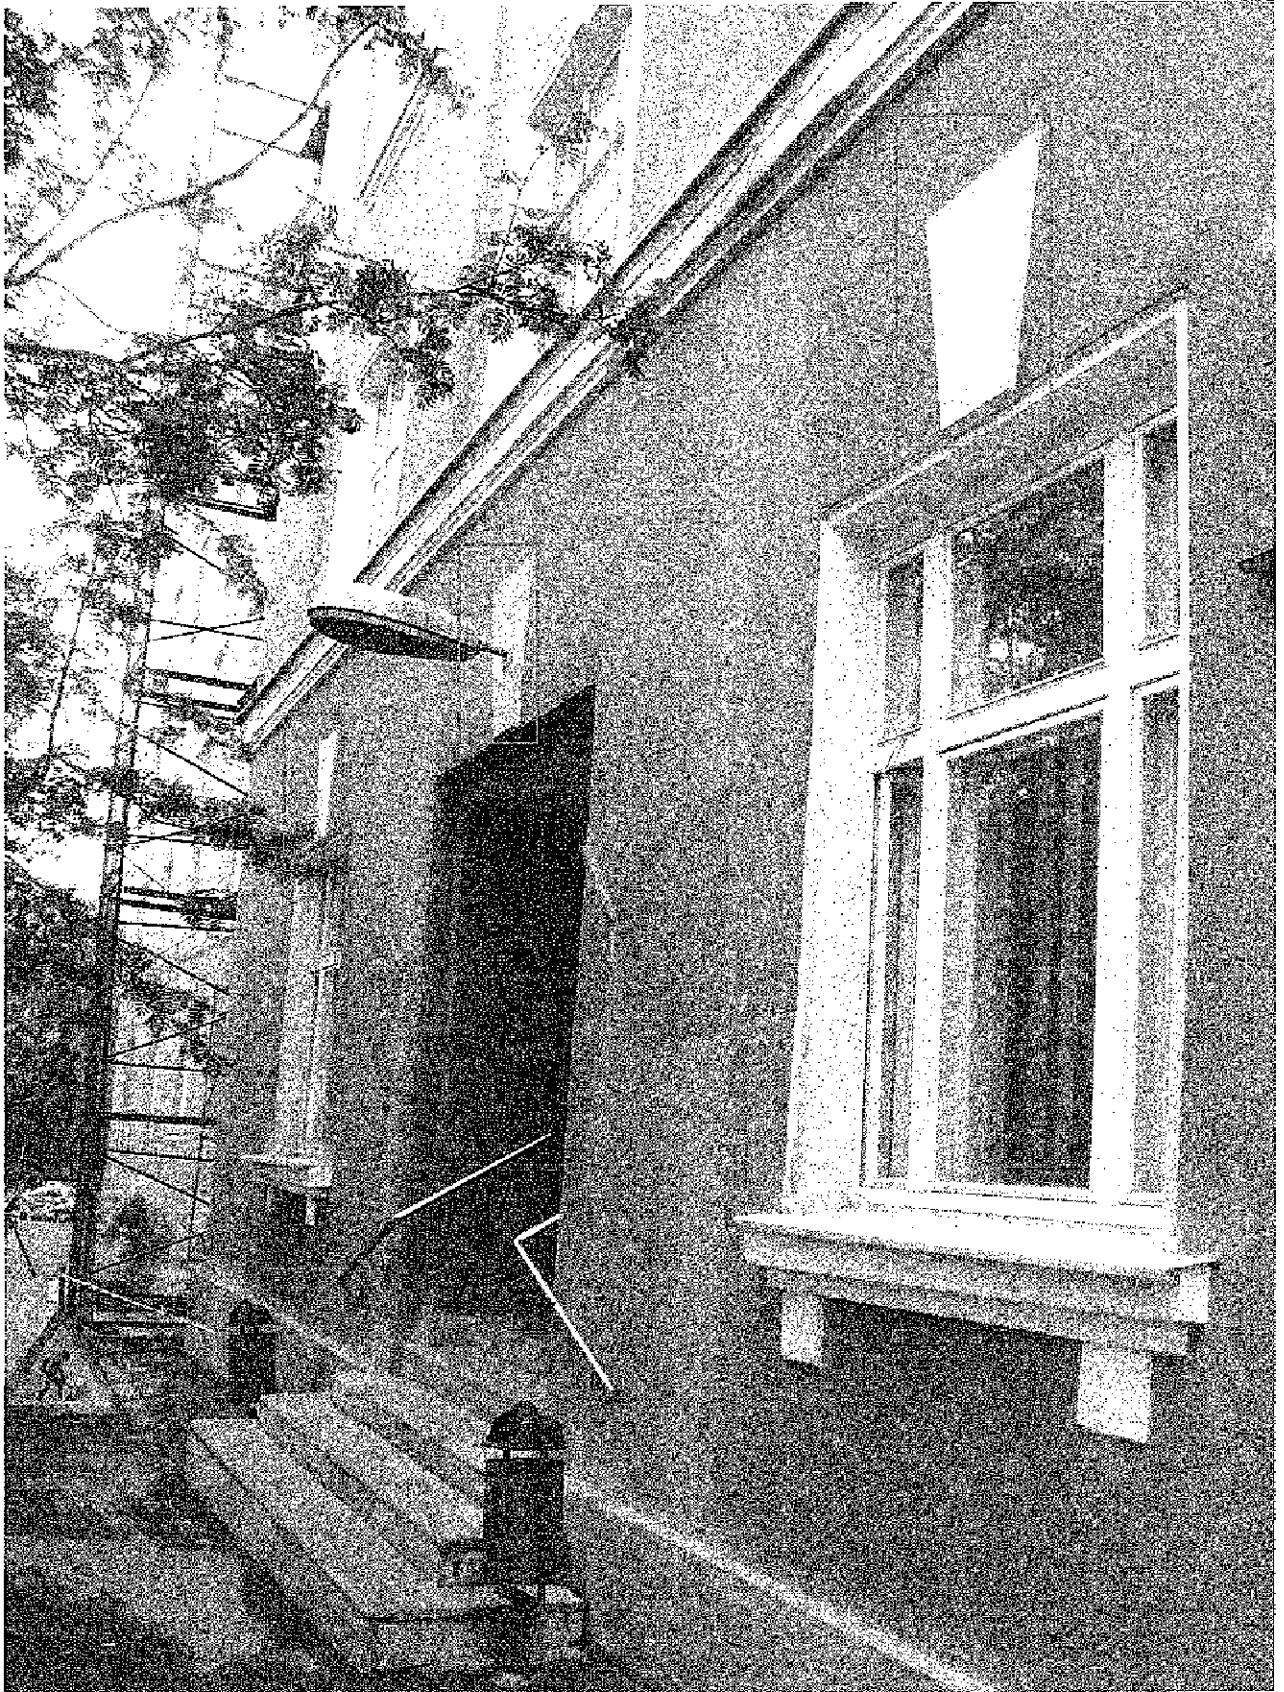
Замковые камни над оконными проемами и дверным проемом 1-го этажа в центральной части южного фасада здания. Дата: 14.07.2021
